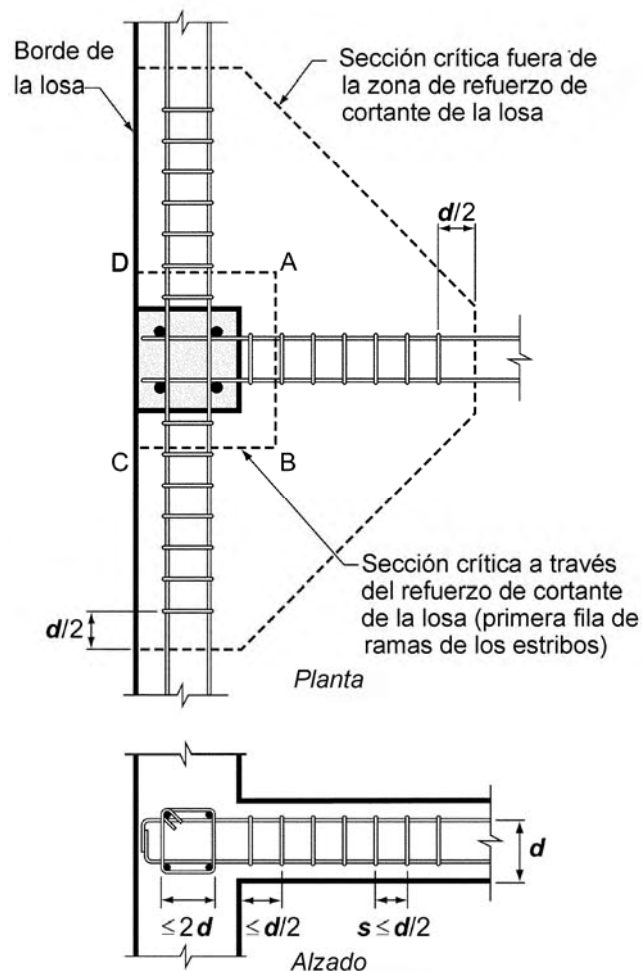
(e) — Disposición de estribos de cortante, borde de columna
